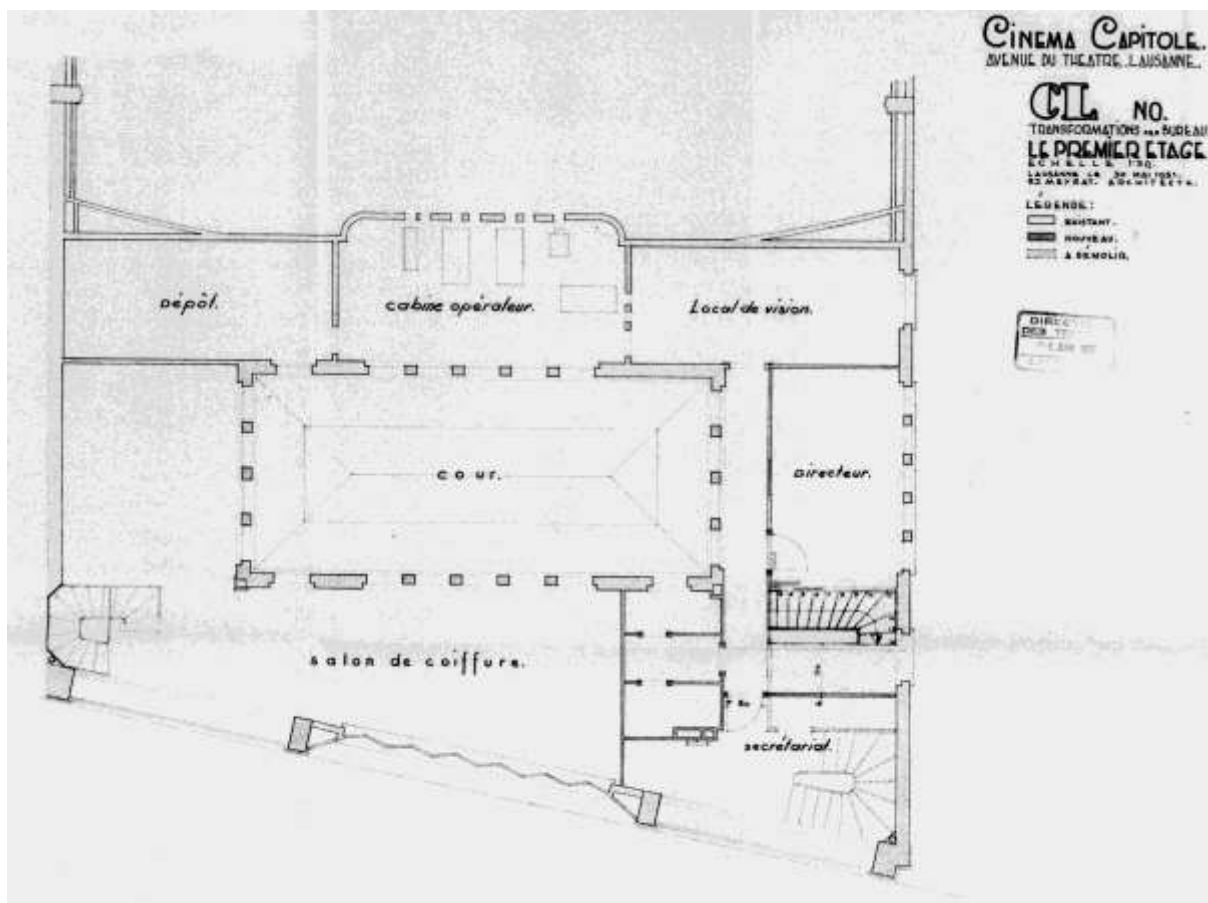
Plan du 1^{er} étage, Ferdinand Meyrat architecte, 30.5.1951 (AVL).
